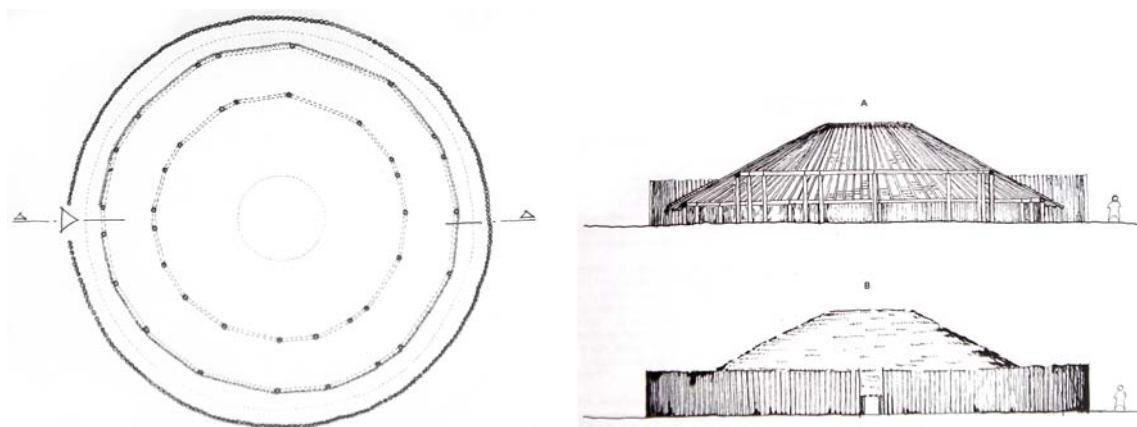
Aldeia-casa Yanoáma: Planta Baixa, Corte e Fachada. Fonte: COSTA, MALHANO, 1987: 69-71.
